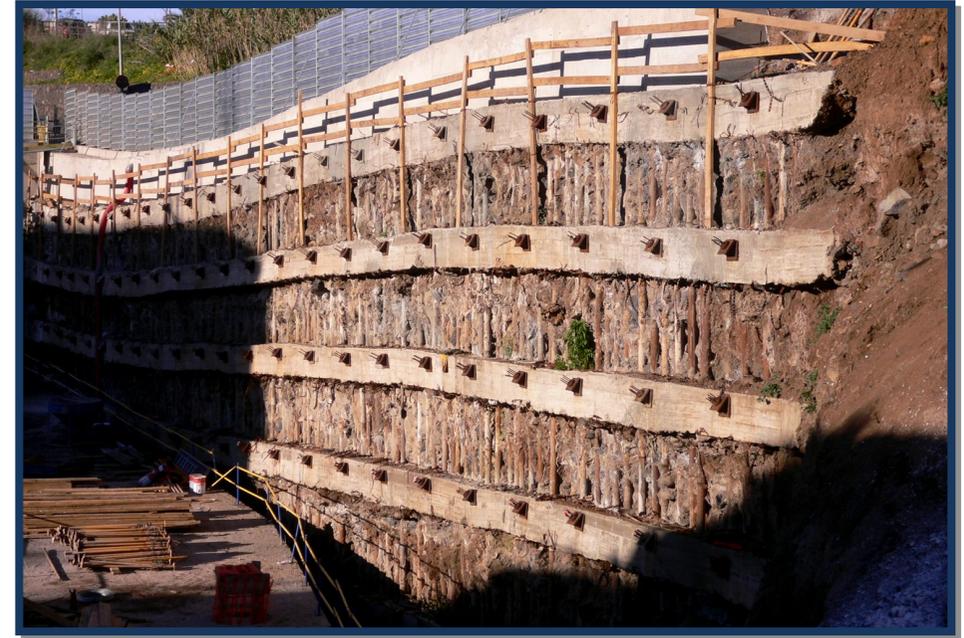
Anclajes unidos mediante viga de hormigón.
